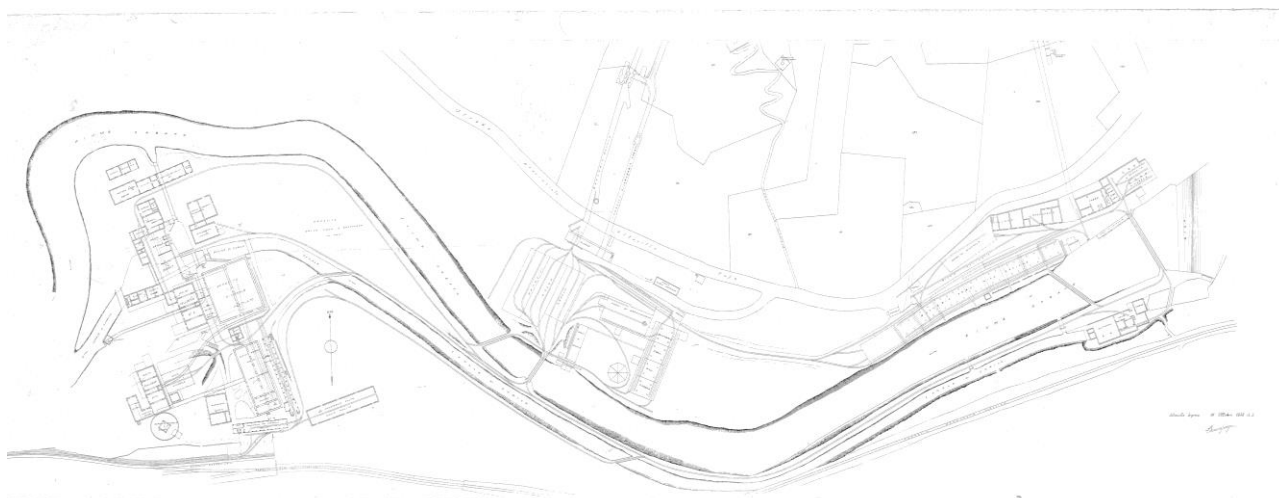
planimetria dei giacimenti solfiferi SAIM e Di Marzo (Archivio privato SAIM).
